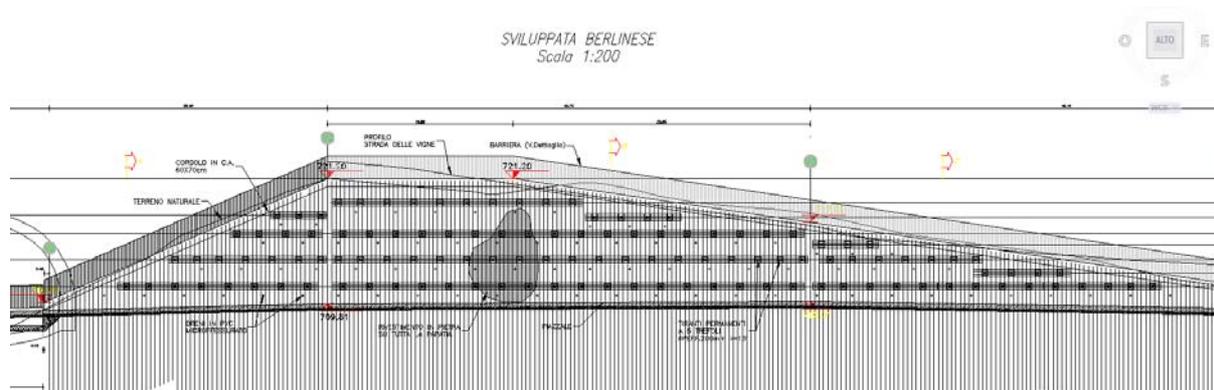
Sviluppata prospetto berlinesi di piazzale
